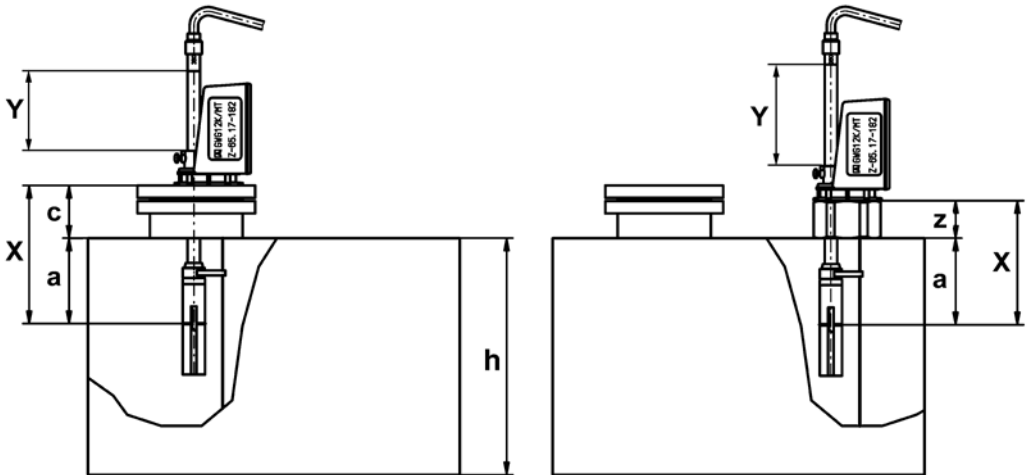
Einbau auf Domdeckel (links), Einbau auf Tankdeckel (rechts)
